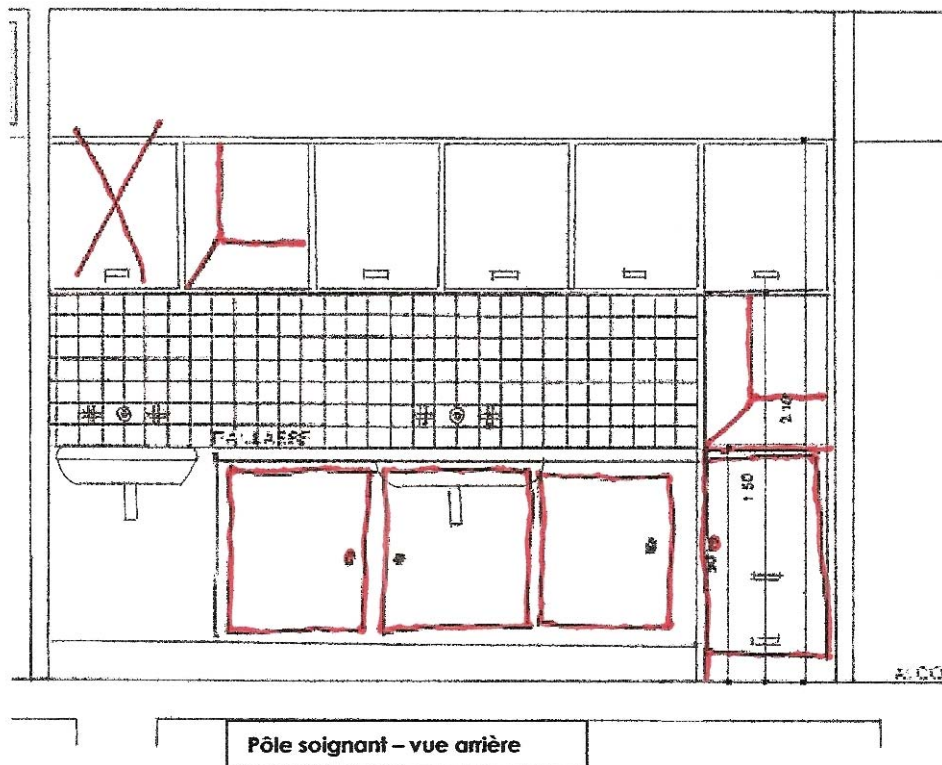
Alteração do detalhamento dos armários detalhados para a bancada de esterilização dos instrumentos de enfermagem, localizada na sala de preparos.
